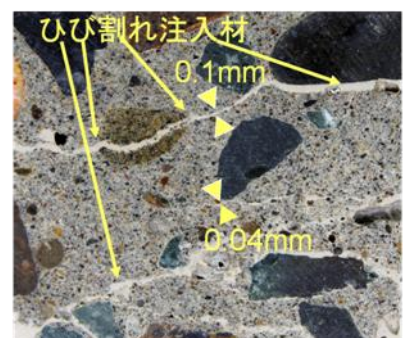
ひび割れ注入材のひび割れ充填状況写真
